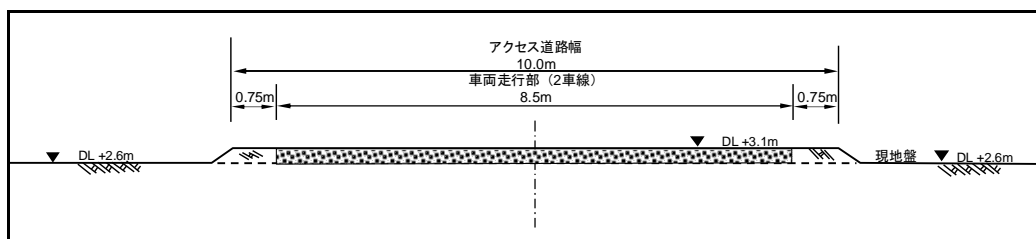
北側アクセス道路の堤防基部陸側の横断面図
